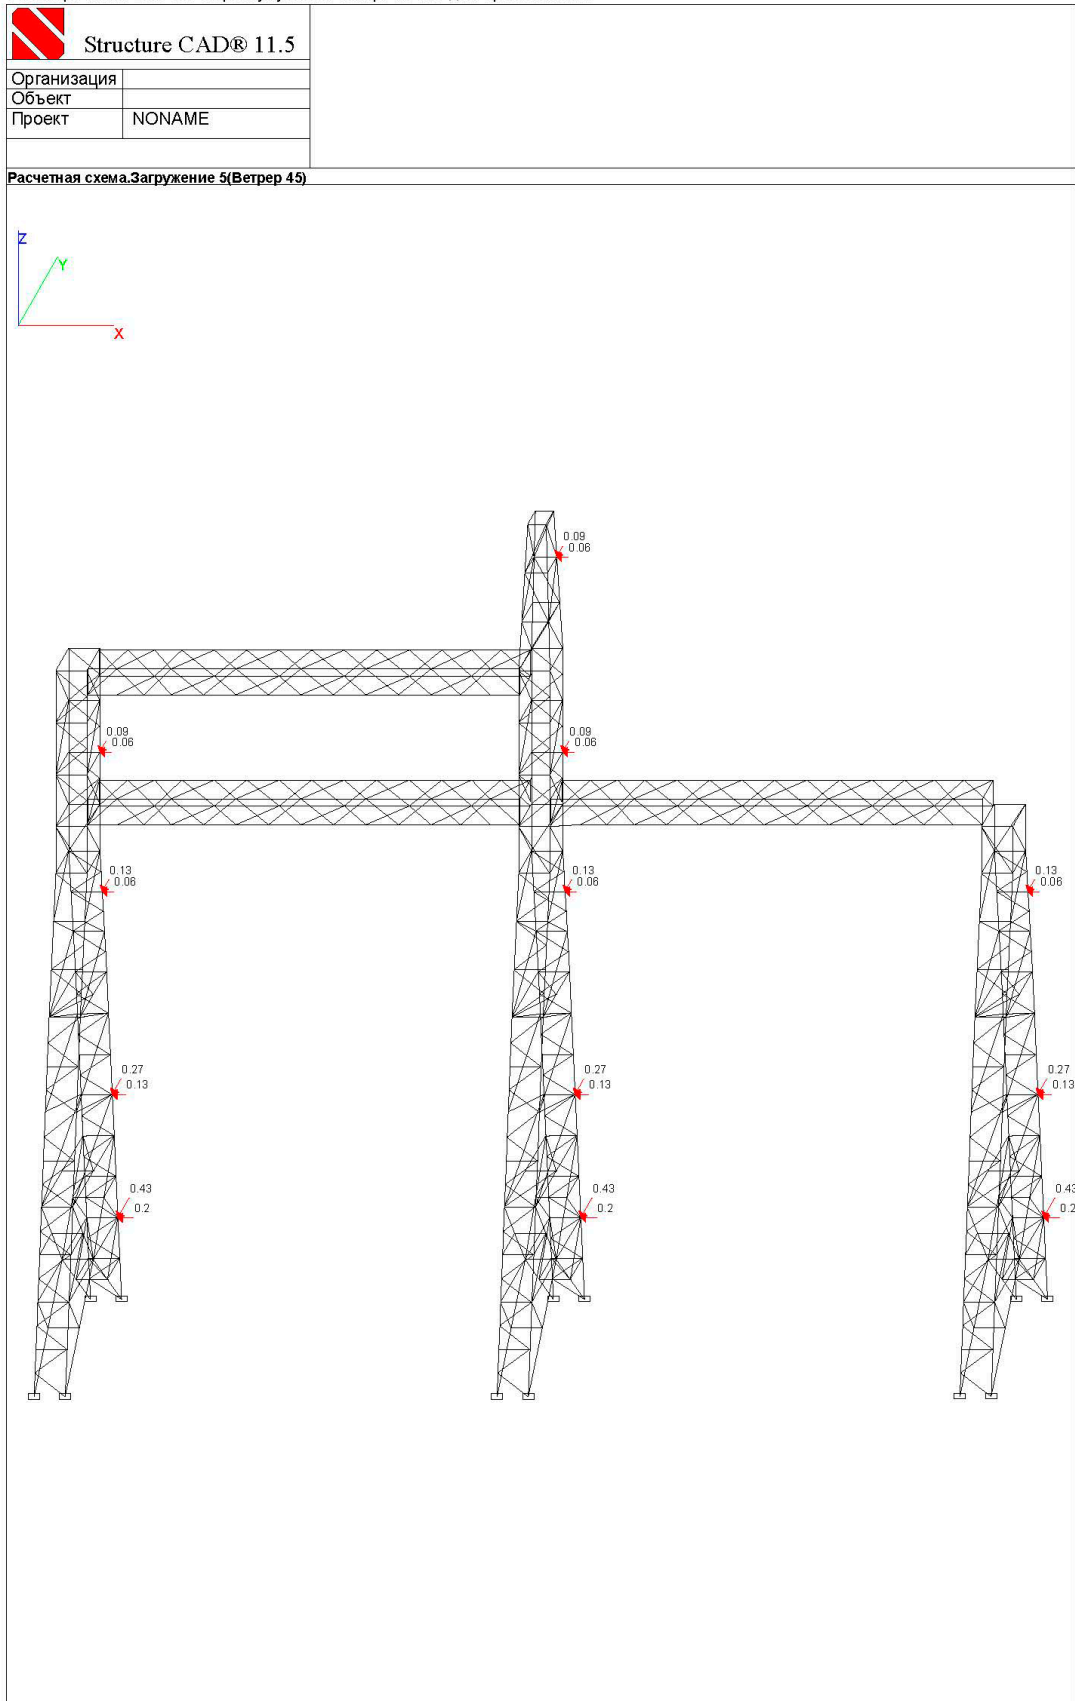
Ветровая нагрузка на конструкцию опоры под углом 45 град.
